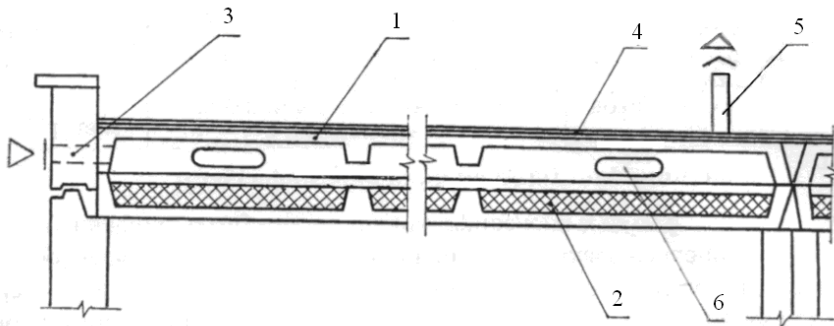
Схема совмещённого вентилируемого покрытия:
